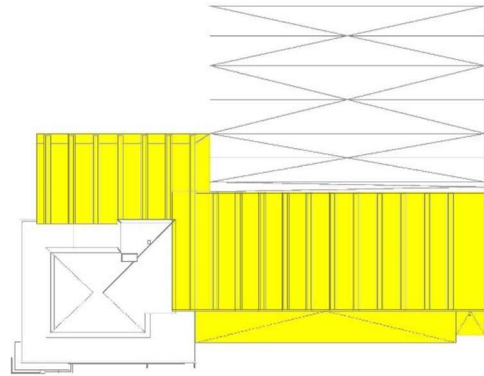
Edifício principal - Primeira fase de construção (Fachada)
